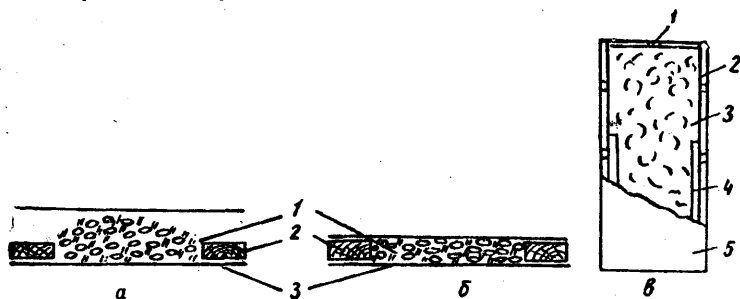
Щитовая дверь, изготовленная с использованием опилок и стружек:
